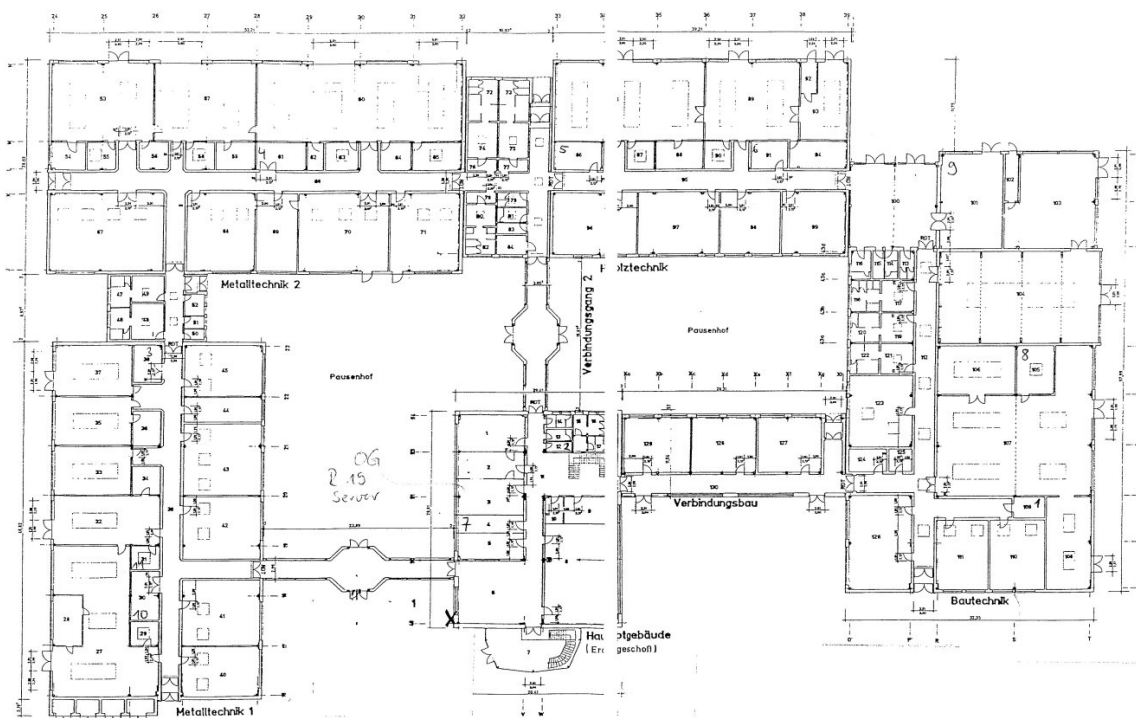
Grundriss der Beruflichen Schule Hagenow
